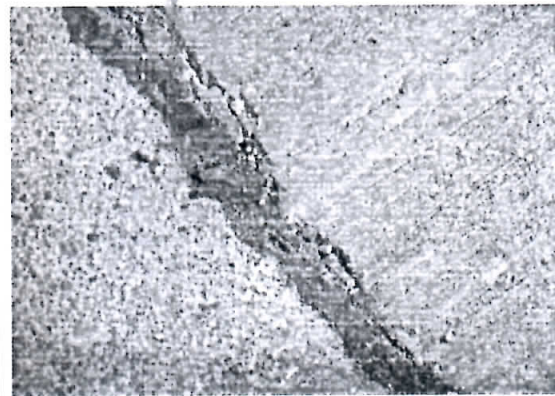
6/03/2015: Solera con emboquillado fisurado en calle Victoria.
